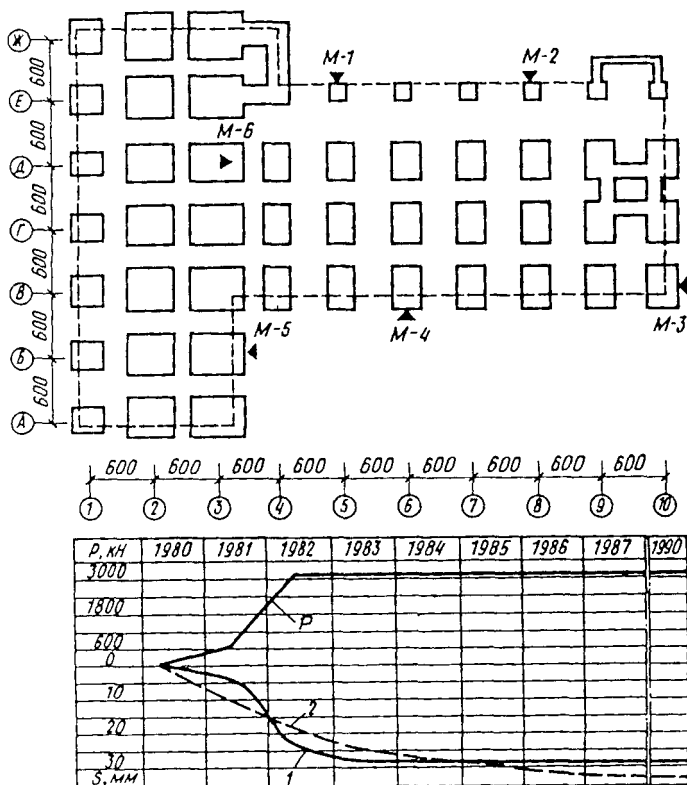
План фундаментов цеха пластмасс и результаты наблюдений за осадками фундамента В-6
